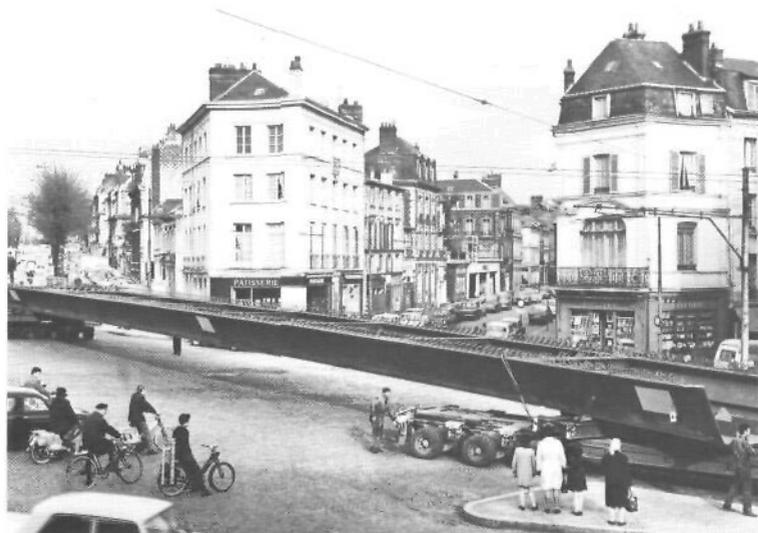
A droite, semi-remorque avant, avec axe de rotation vertical au droit de l'appui. A gauche, triqueballe arrière. Le caisson qui recevra une dalle en béton, est entretoisé sur toute sa longueur.
